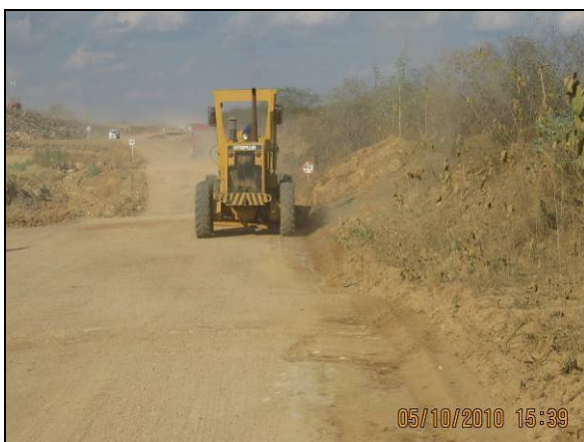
Manutenção em via de acesso no segmento WBS 2223 (out/10).
